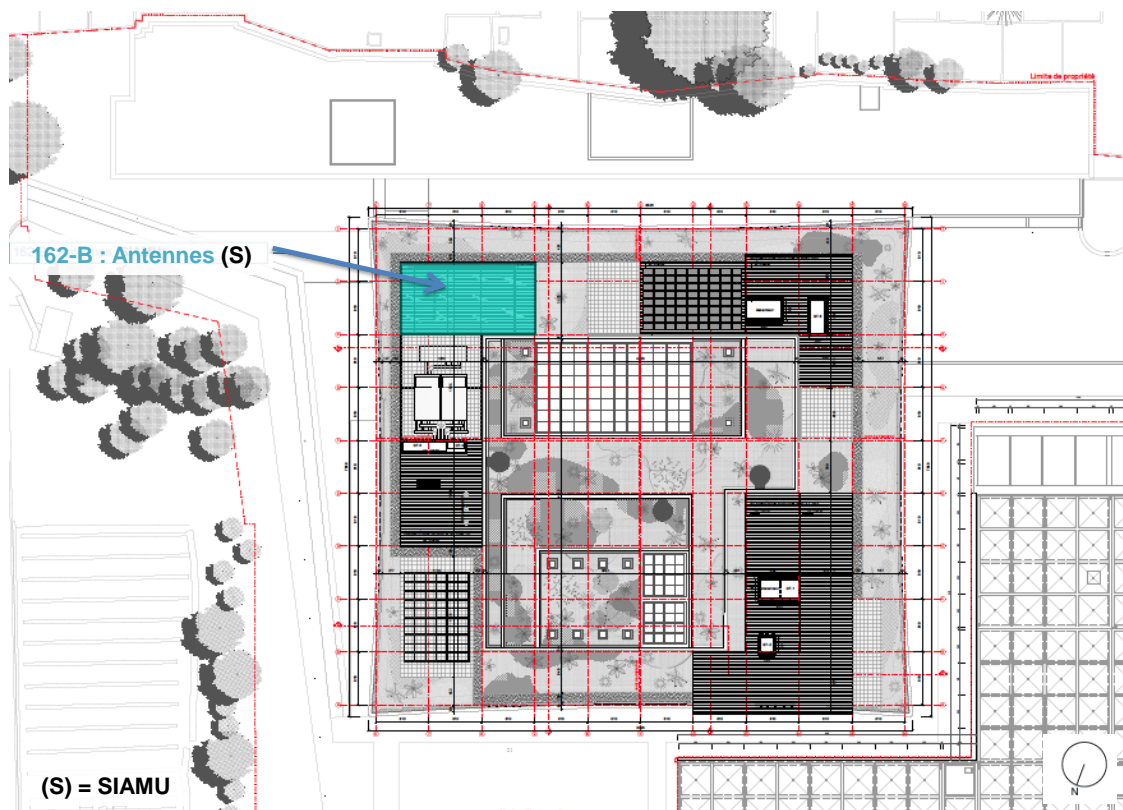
Installations classées implantées au niveau de la toiture du bâtiment principal
